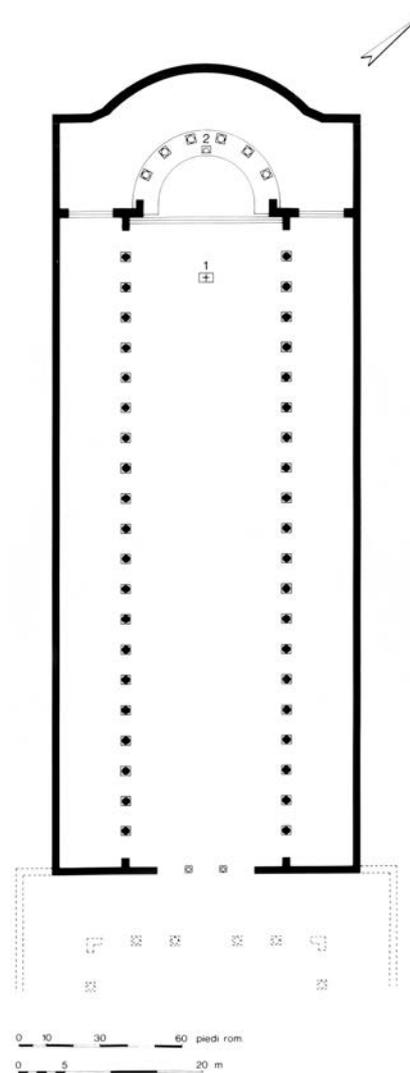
Rom, S. Maria Maggiore, Grundrissrekonstruktion 5. Jh. (nach De Blaauw 1994)
